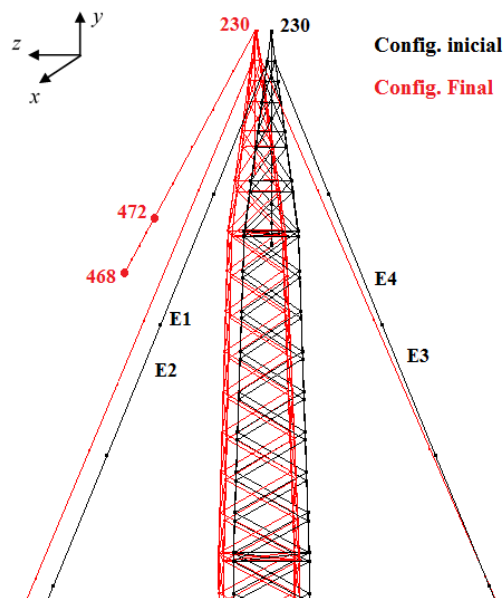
Vista longitudinal (plano zy) da deformada da parte superior da torre cross rope - Hipótese III
